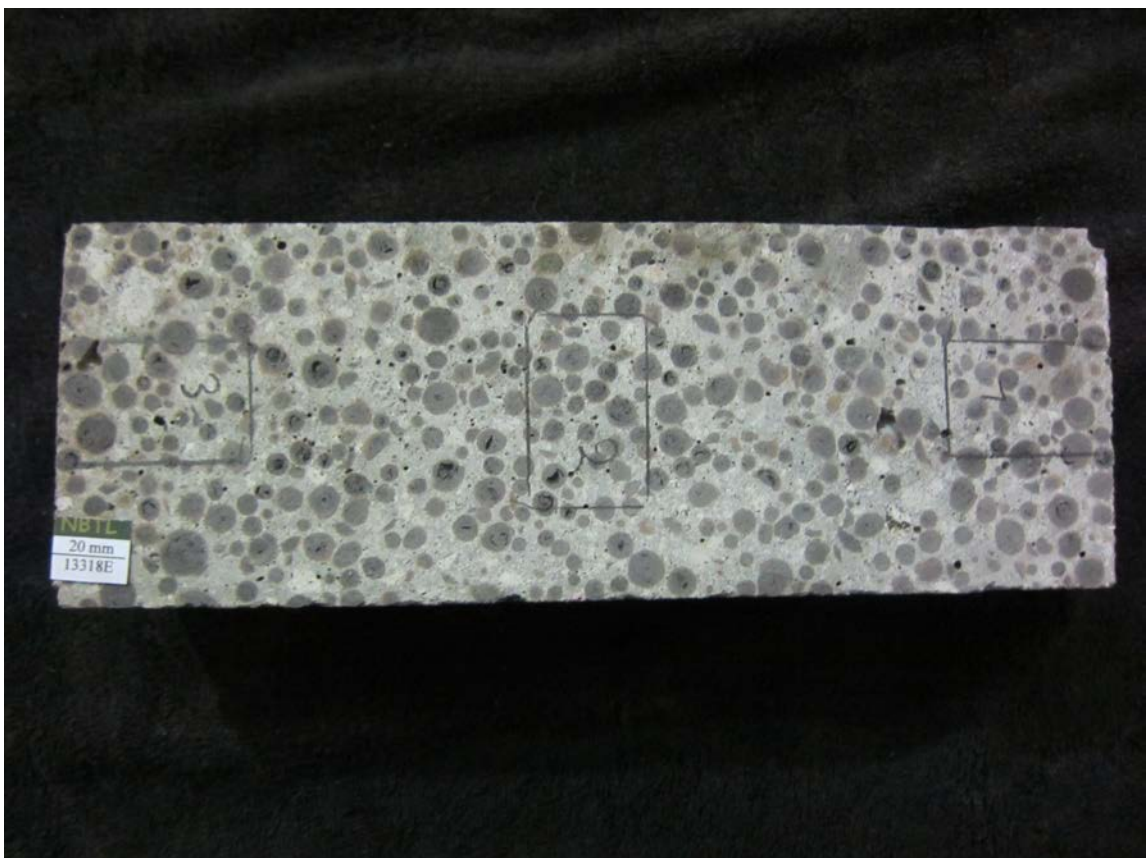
Plassering av tynnslip i prøven. Sørsiden er til venstre i bildet
